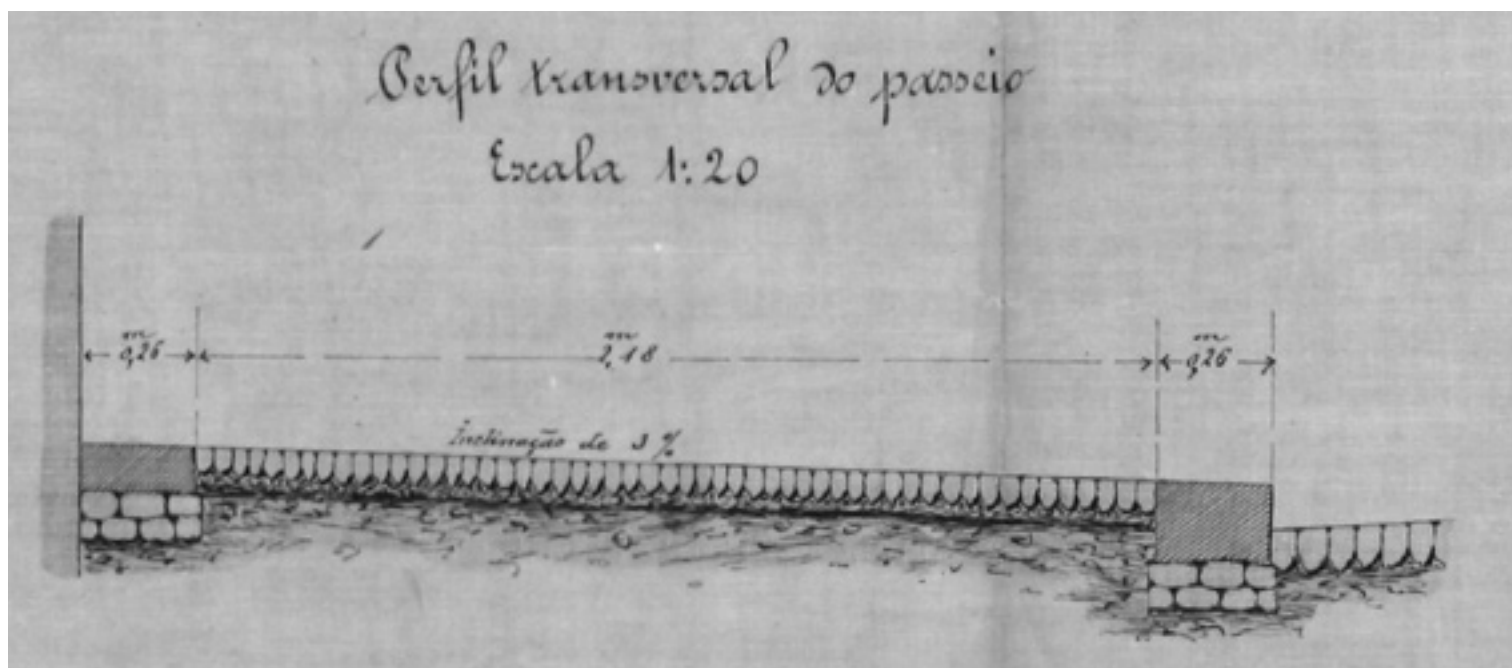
Augusto Cesar dos Santos. Sección Rua Garret, 1887 (AML-AC). El perfil transversal para la pavimentación de la Rua Garrett esquematiza la sección tipo de las calles de Lisboa, donde los cubos de piedra calcárea se asientan en una capa de polvo de piedra sobre una base de arena compactada. Este sistema facilita su implantación sobre el terreno variable y cambiante de la ciudad
